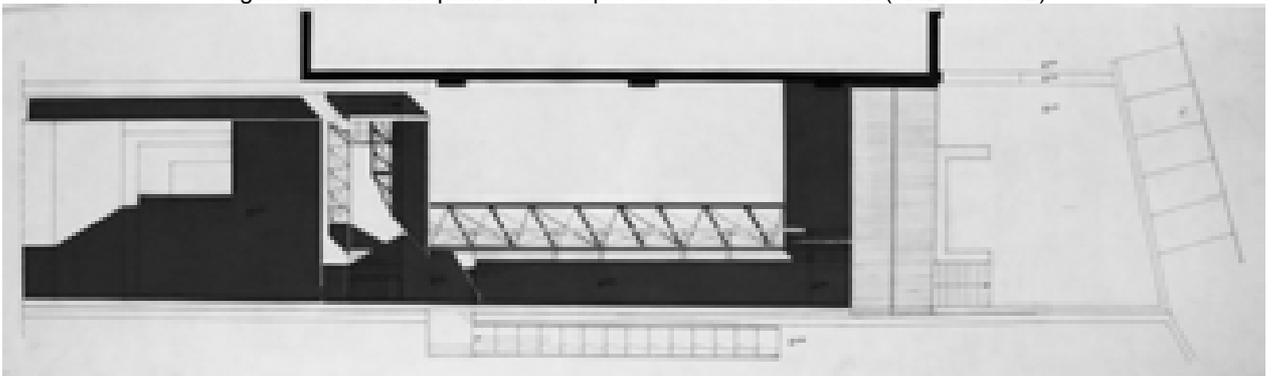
Studio planimetria generale – stato futuro - s.d. (AABS-95.301)
